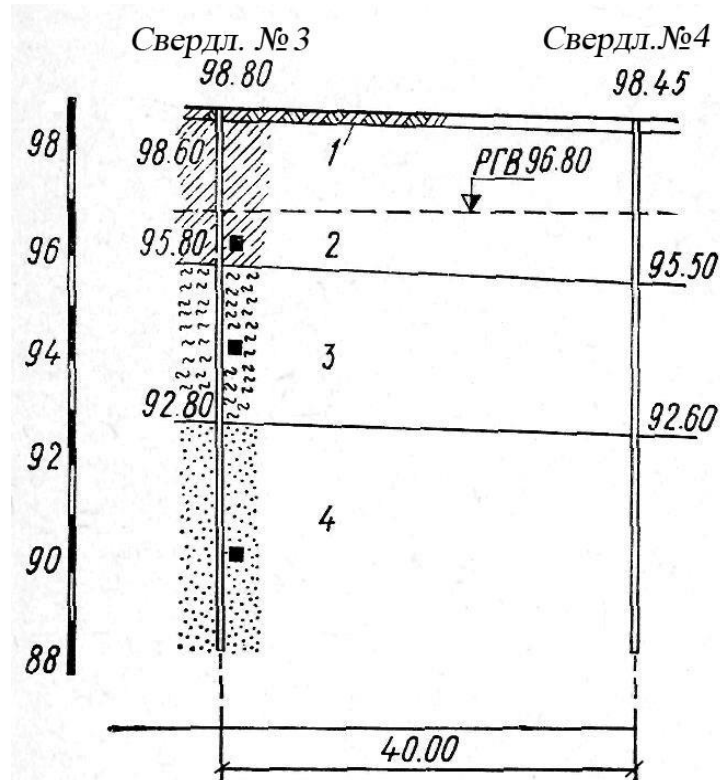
Геологічний профіль будівельного майданчика № 2:
